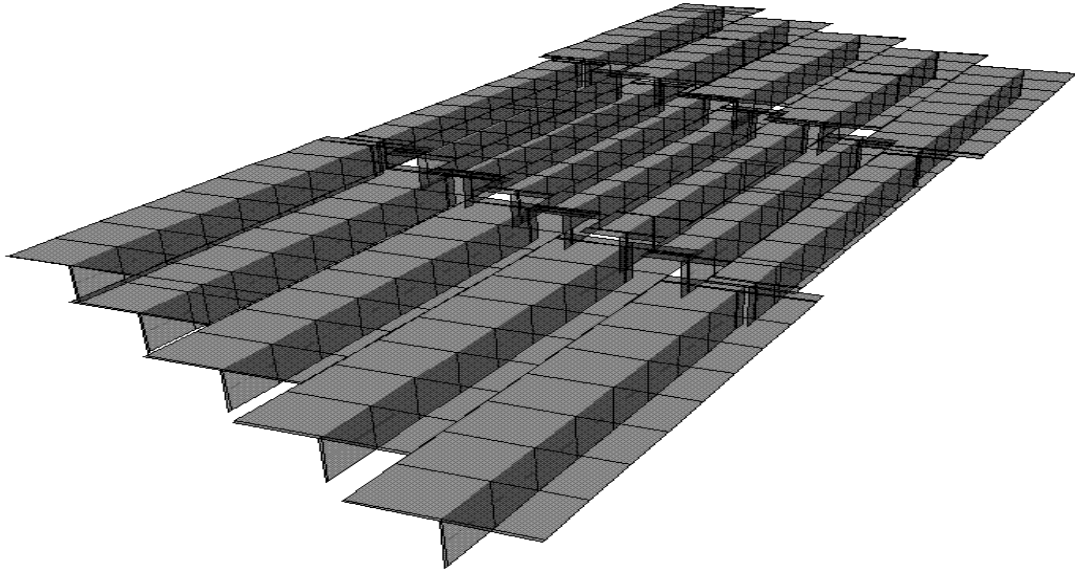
Idealizaion de la placa del puente FF.CC como vigas T en elementos Frame en Sap 2000
